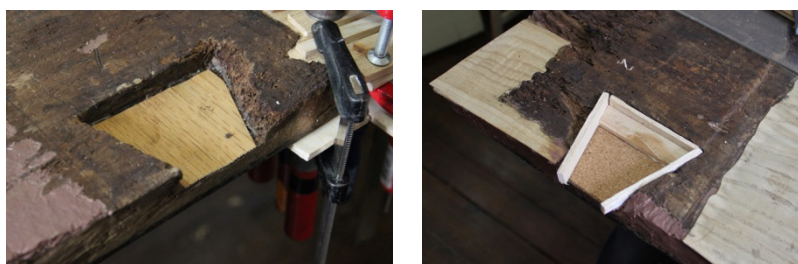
Pormenor com a folha de castanho no local outrora preenchido com o malhete de dupla terminação trapezoidal (© Susana Mendes, 2014).
